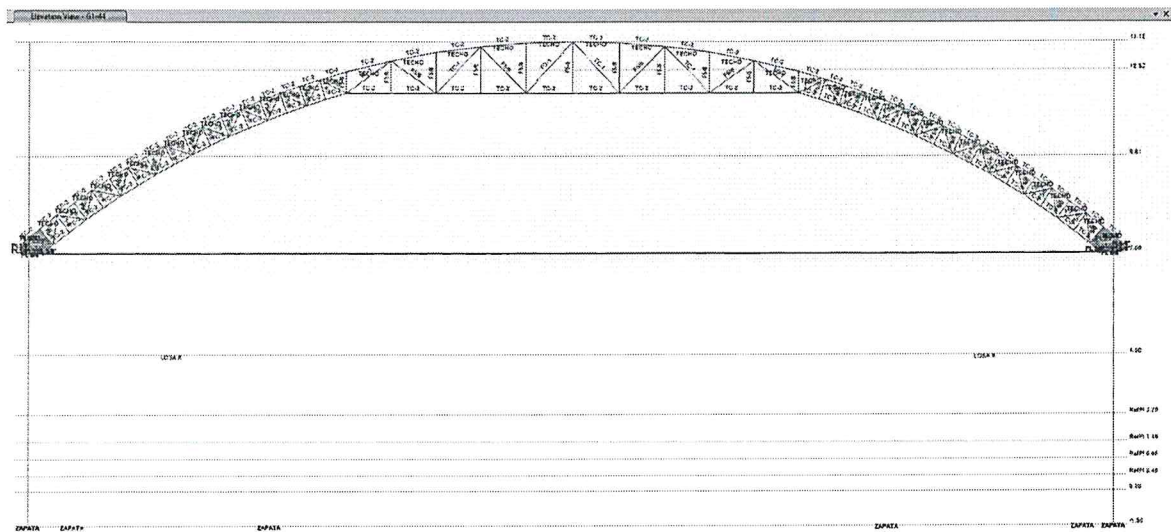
Vista en Elevación del modelo estructural de la Edificación 19-20 sistémico analizado. Los elementos no estructurales fueron ingresados como cargas permanentes
